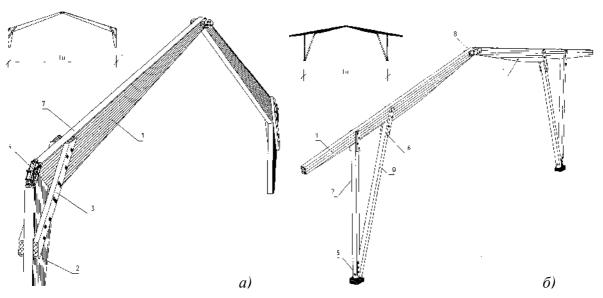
Двухподкосная рама (а) и рама с внутренними опорными подкосами (б): 1 – ригель рамы; 2 – стойка рамы, 3 – дощатый подкос на стяжных болтах, 4 – монтажный стык, 5 – фундамент с анкерными пластинами, 6 – деревянные накладки с овальными отверстиями, 7 – защитная доска на клею, 8 – коньковый узел с деревянными накладками, 9 – цельнодеревянный или клееный подкос
